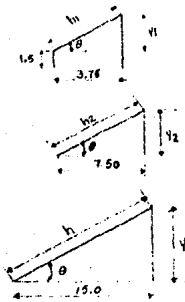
Elevación Tipo de la Armadura de Techo
